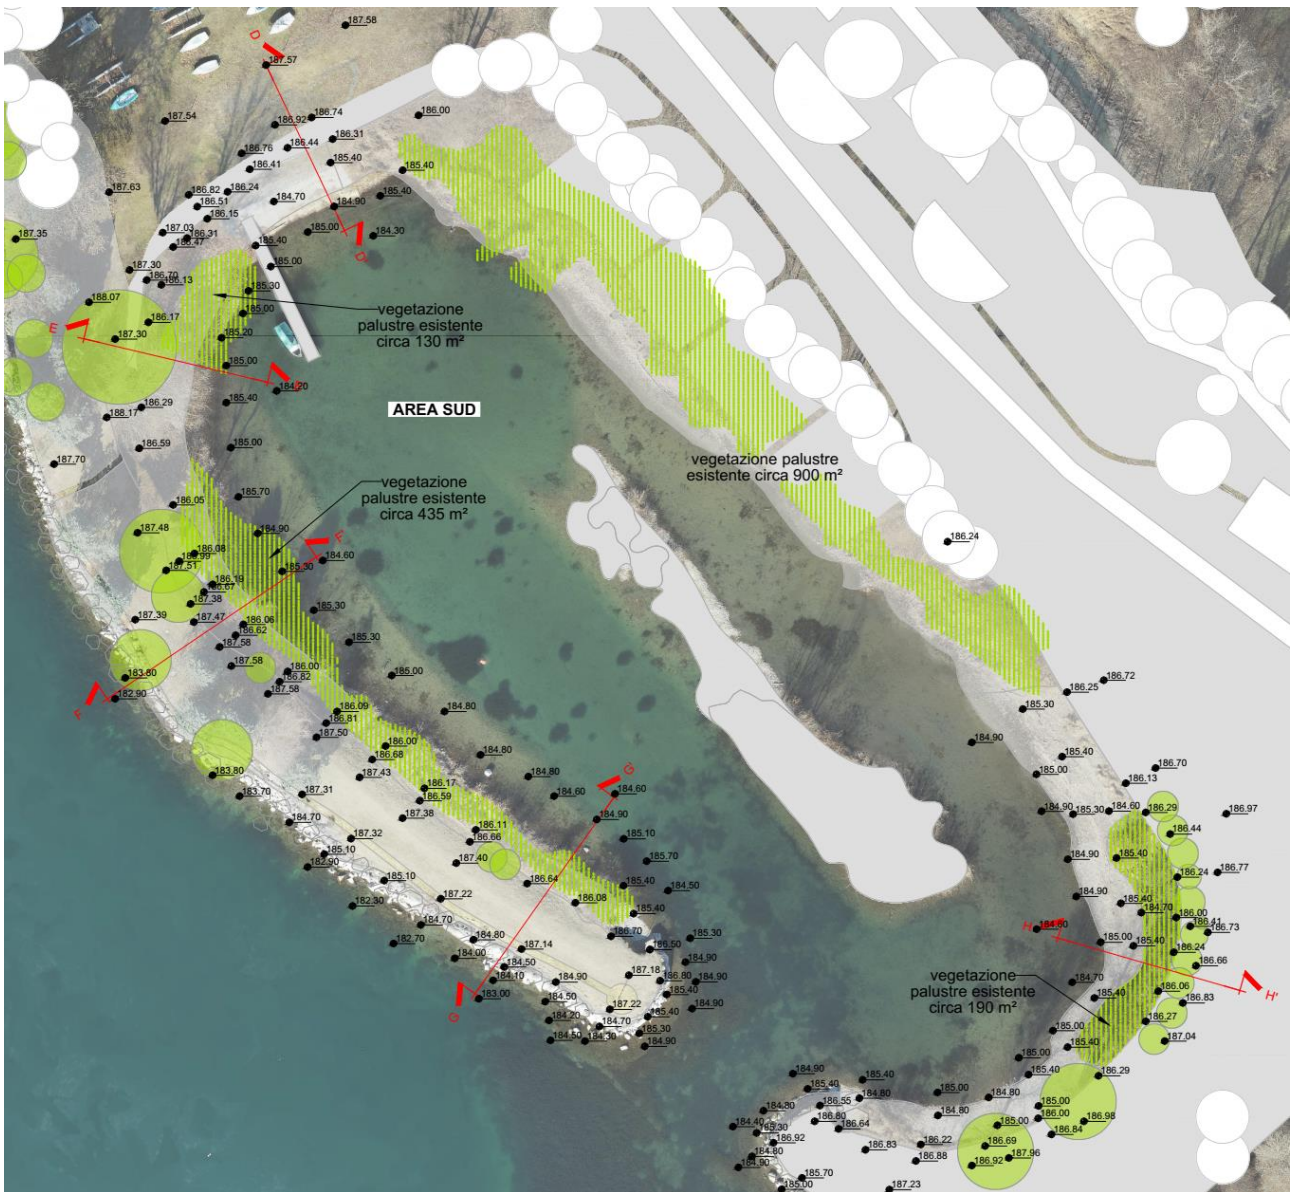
Zoom planimetria stato di fatto area a sud con indicazione sezioni
